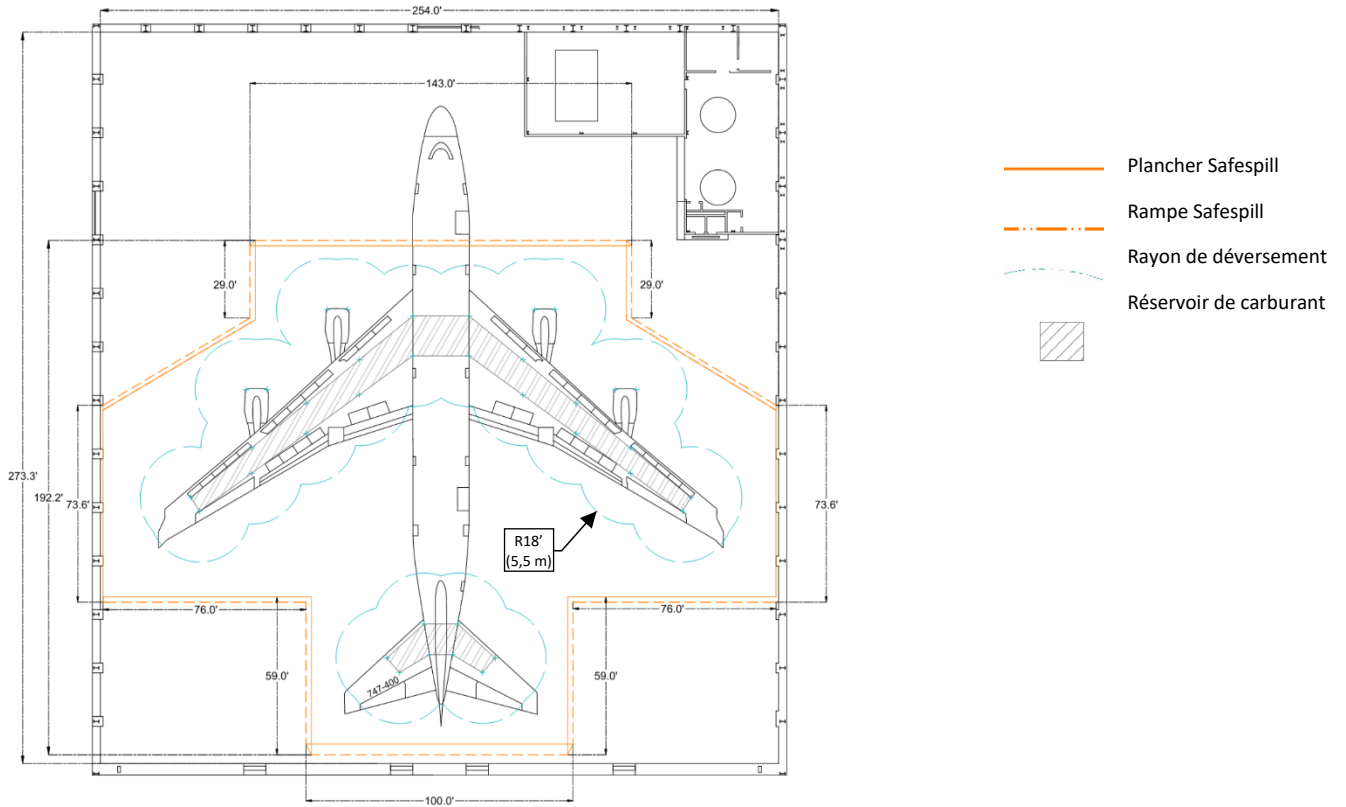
Exemple de hangar Boeing 747-400 conçu avec un ILDFA réduit couvrant uniquement les zones de déversement potentielles
